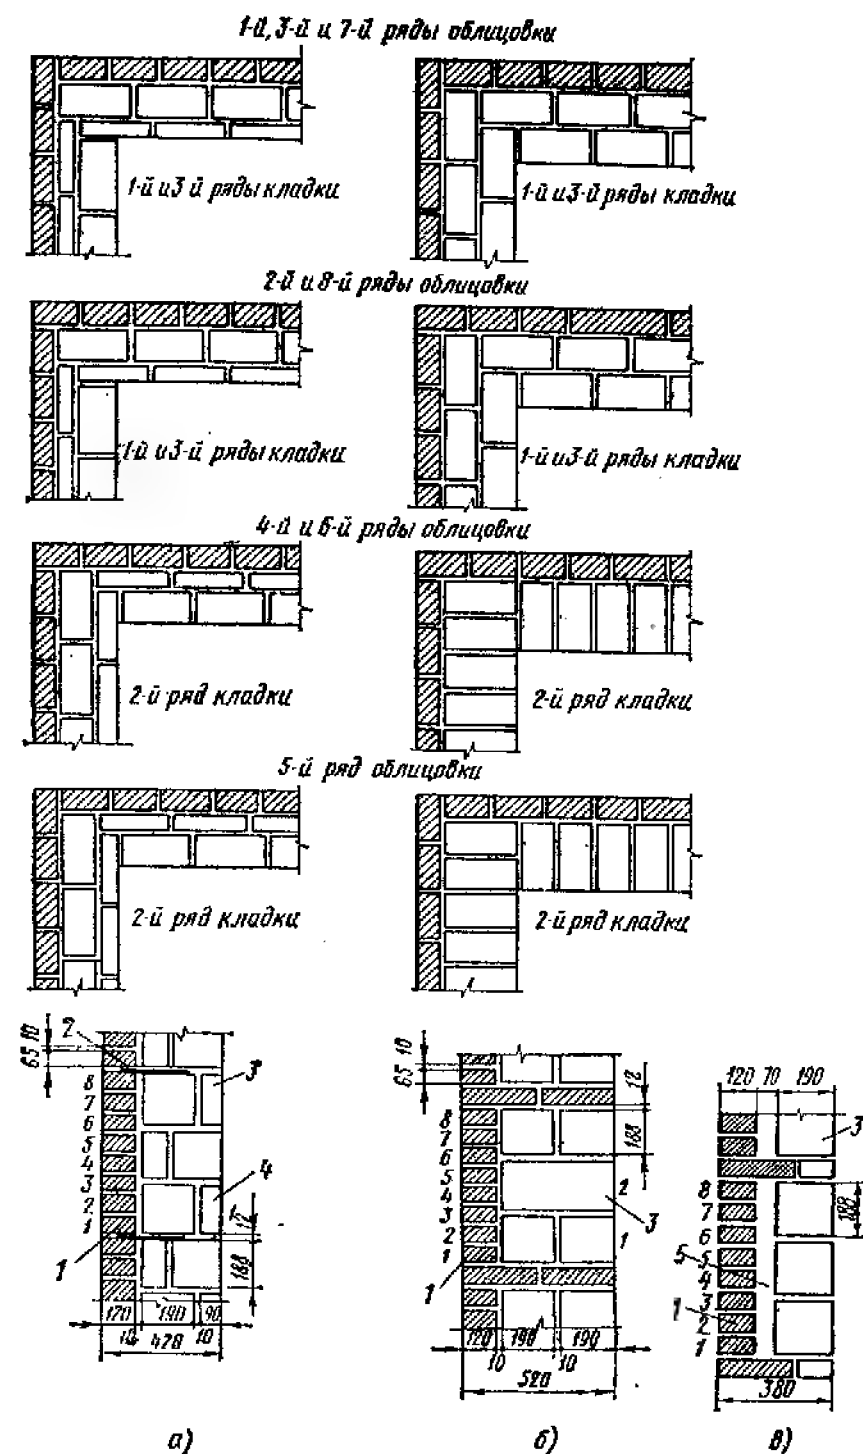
Кладка из легкобетонных камней с облицовкой кирпичом: а — из камней со щелевидными пустотами без прокладного ряда, б — из трех пустотных камней с прокладным рядом, в — с уширенным вертикальным швом; 1 — облицовочные ряды, 2 — металлические скобы, 3 — ряды кладки камней, 4 — камень со щелевидными пустотами (продольная половинка), 5 — уширенный вертикальный шов
